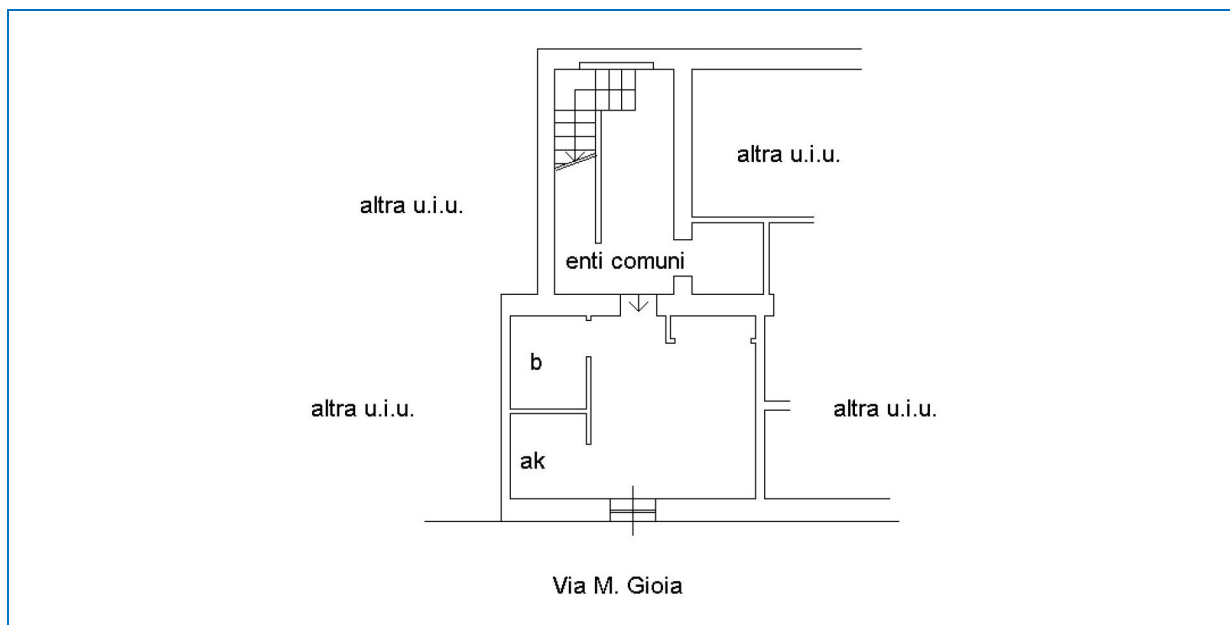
estratto planimetria catastale dell'appartamento sub. 730
